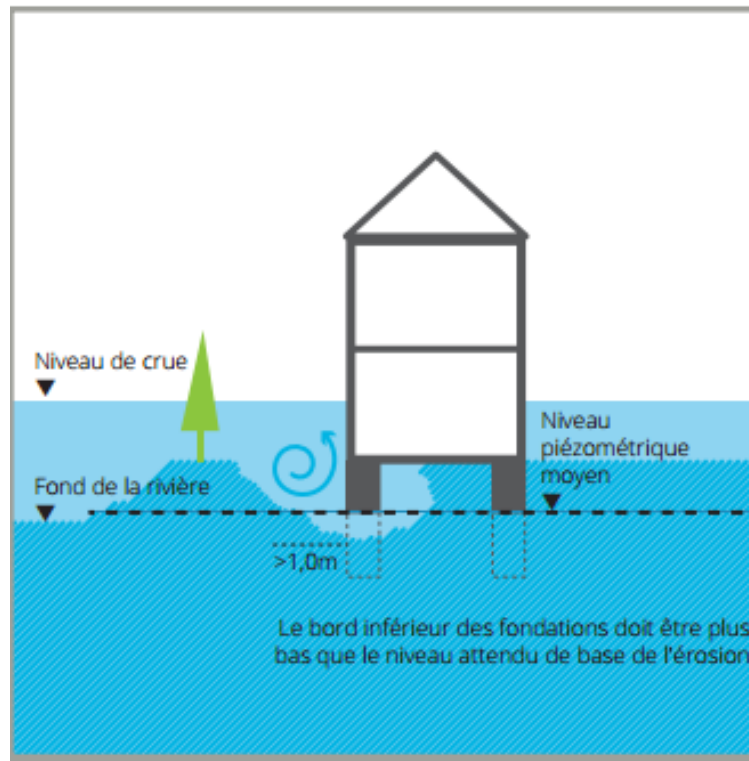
Fondations déchaussées (phénomène d'affouillement) [17].
